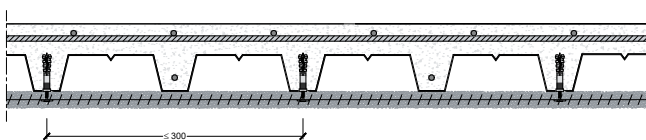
Schema di applicazione per protezione di soletta in lamiera grecata con getto collaborante in C.A.
